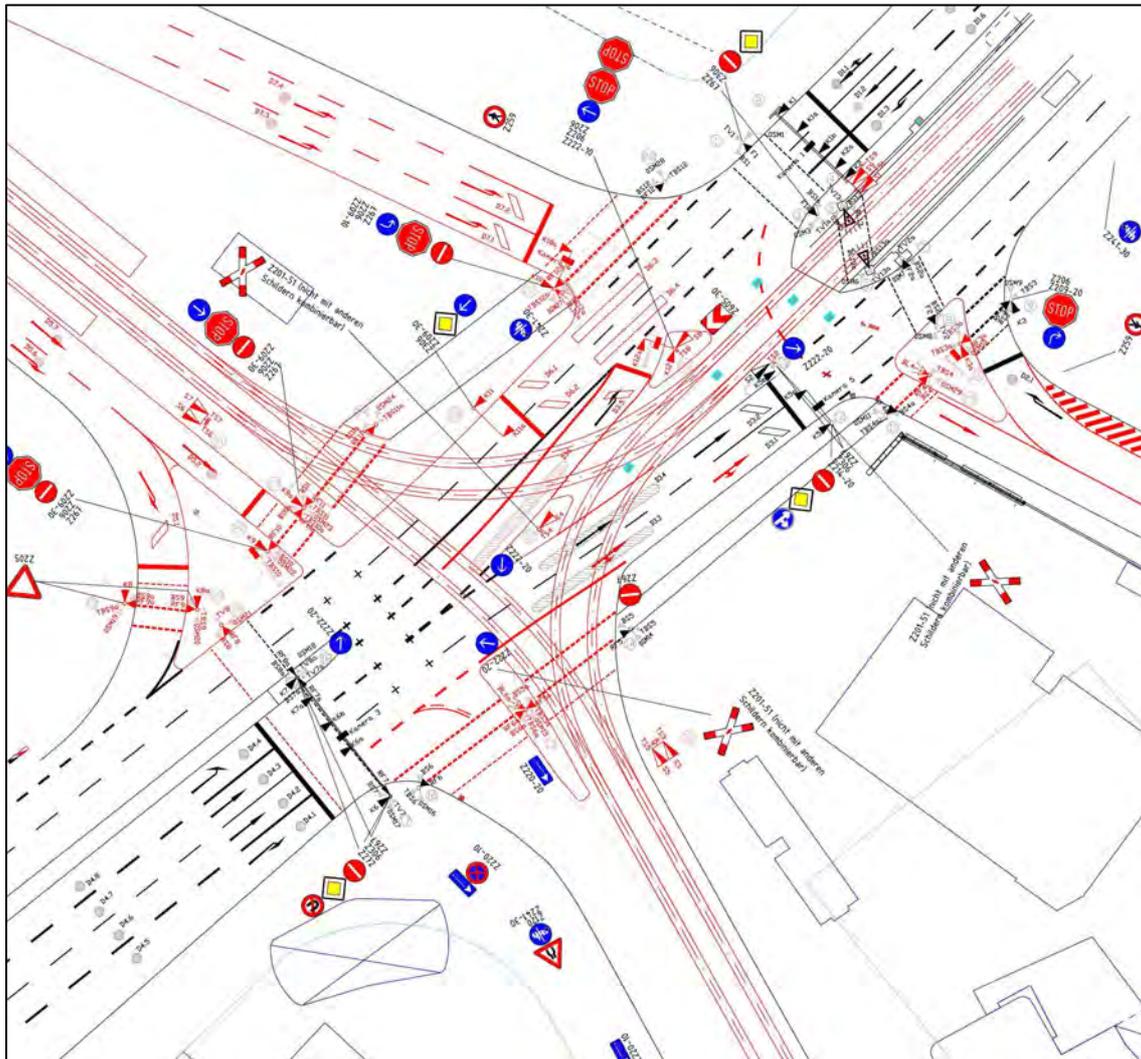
Signallageplan K122 Montpellierbrücke, Variante mit Underfly
